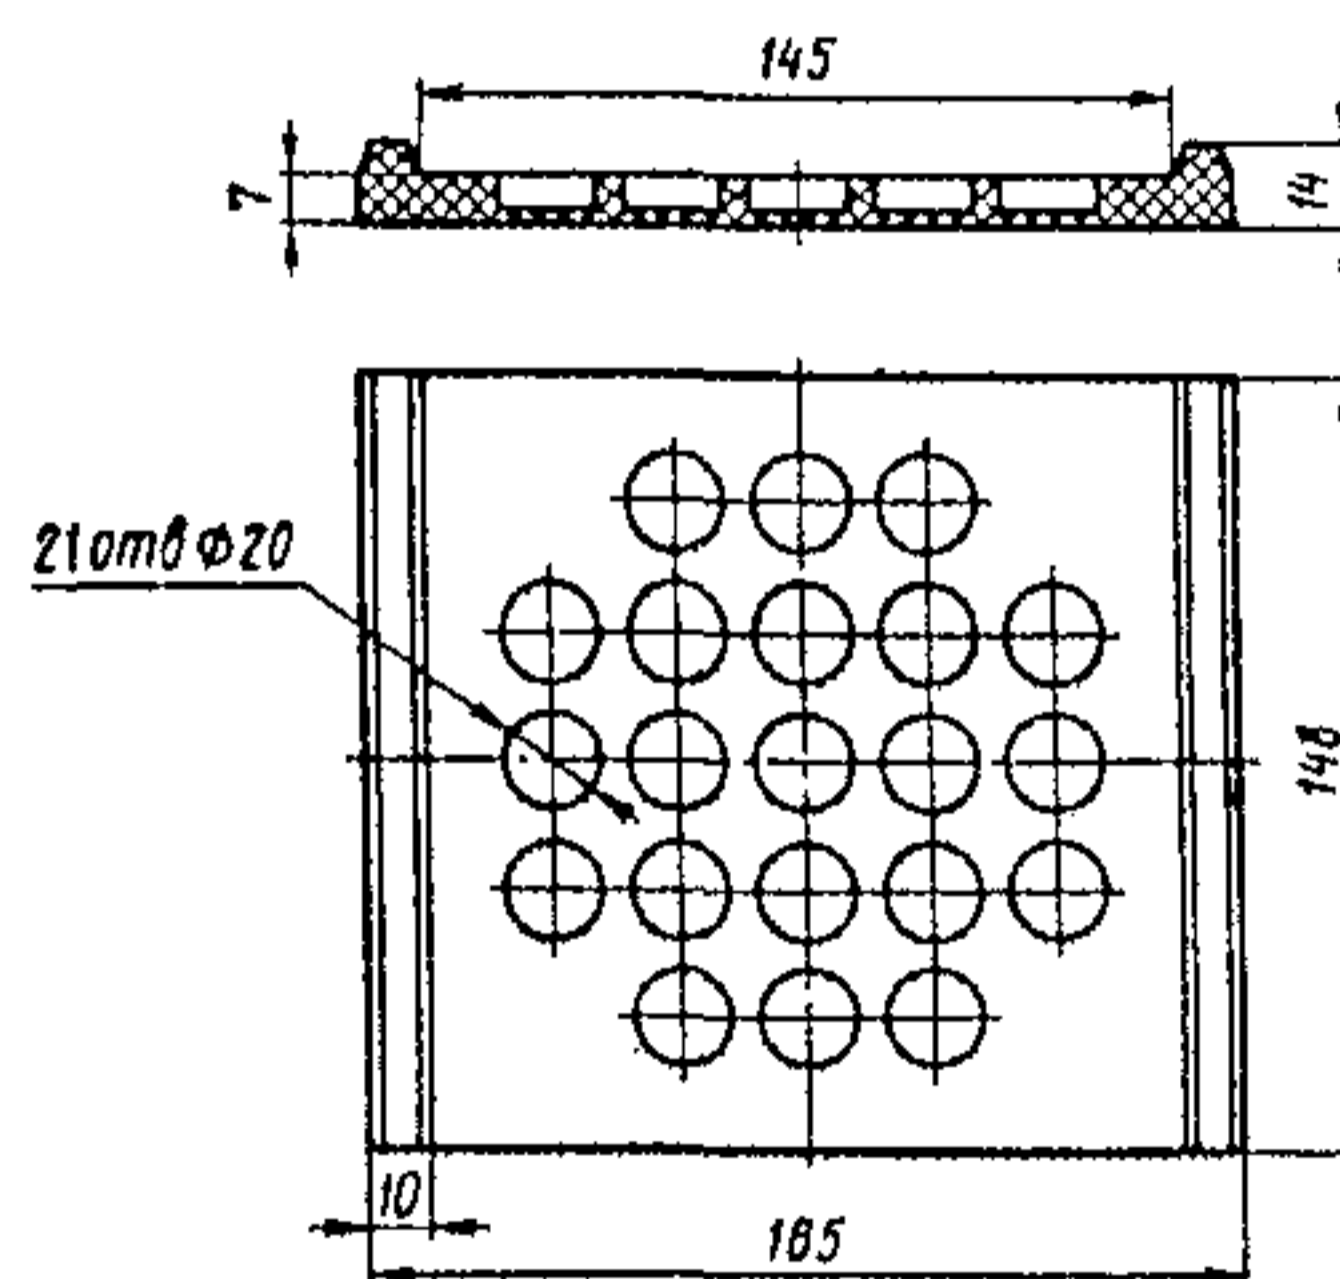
Прокладки под рельсовые подкладки и путевые рельсы Р65 на железобетонных шпалах
